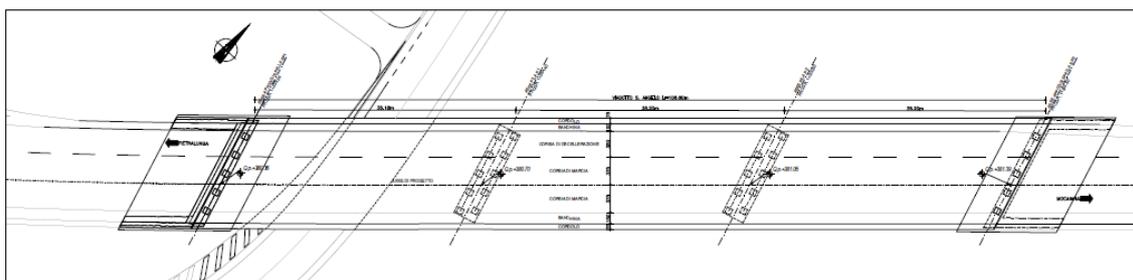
PLANIMETRIA VIADOTTO S. ANGELO
